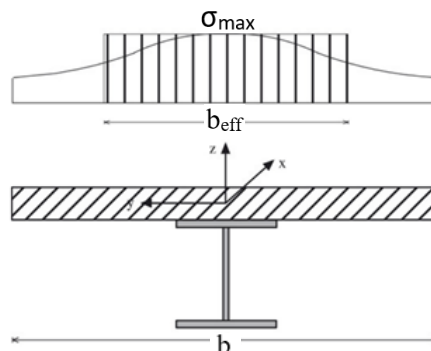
Largura efetiva da laje (CASTRO; ELGHAZOULI; IZZUDDIN, 2007)
